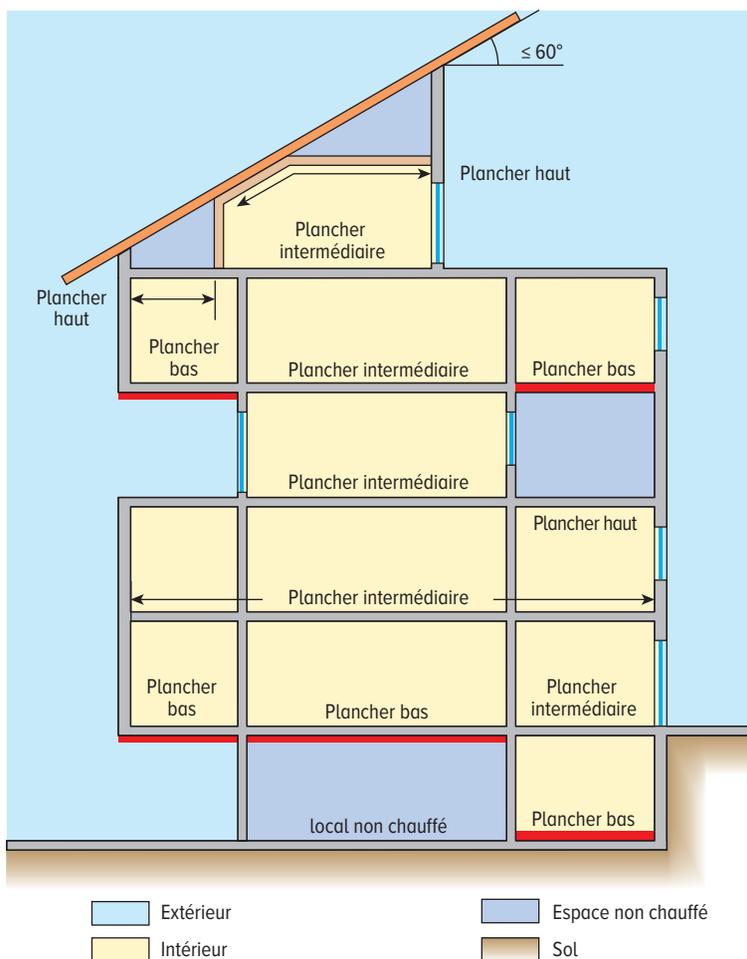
Définition d'un plancher bas au sens de la réglementation thermique
